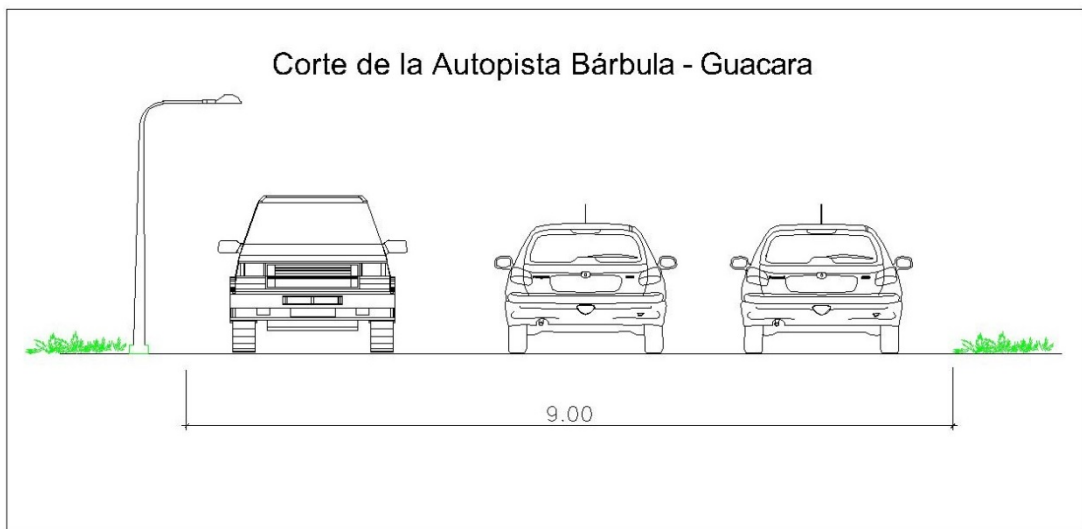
Vista de corte de la Autopista Bárbula - Guacara
